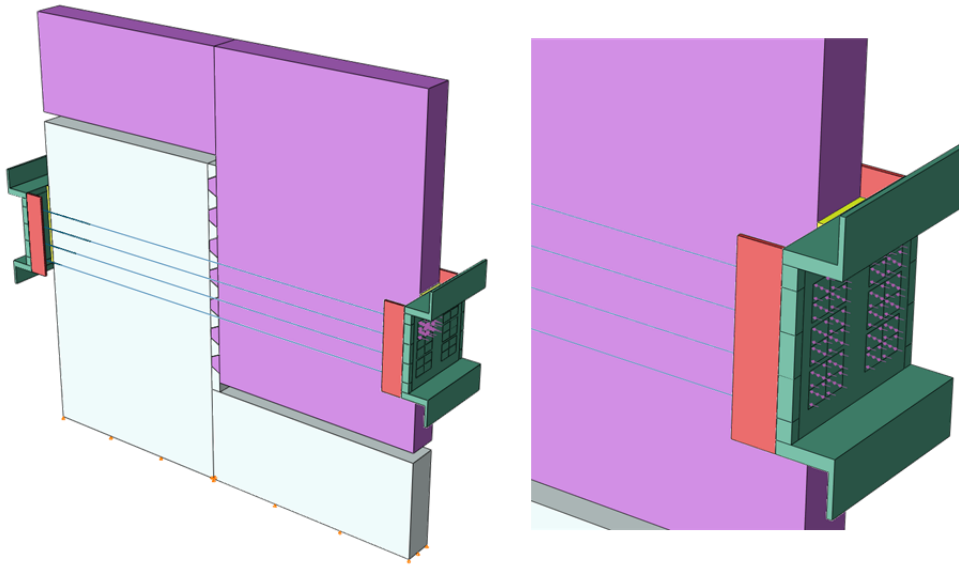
Modelo del ensayo de la junta de siete llaves y elementos auxiliares, reforzado con la platabanda de 20 mm, plancha de neopreno y pestañas de 10 mm, para el caso de tesado de un solo cable (izquierda) y seis cables (derecha, detalle)
